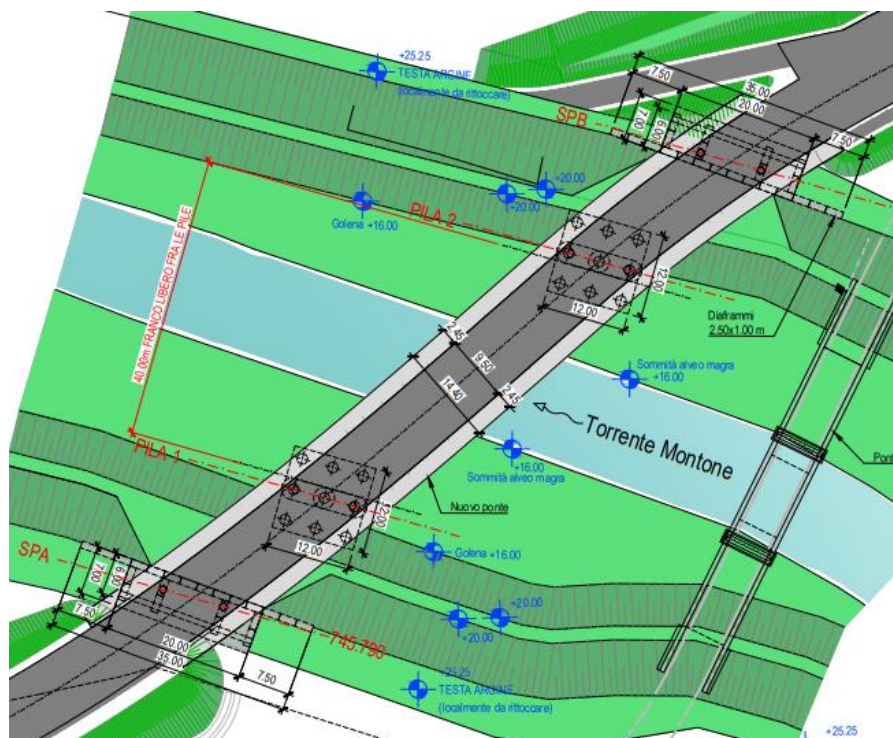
Vista in pianta del nuovo ponte sul torrente Montone
